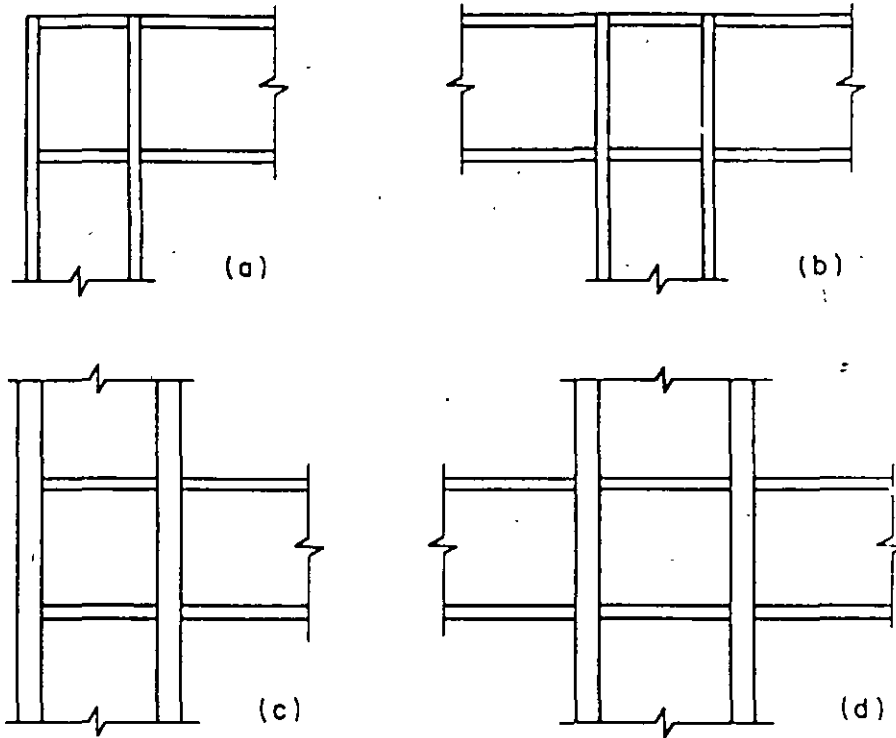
Conexiones viga-columna de marcos rígidos
